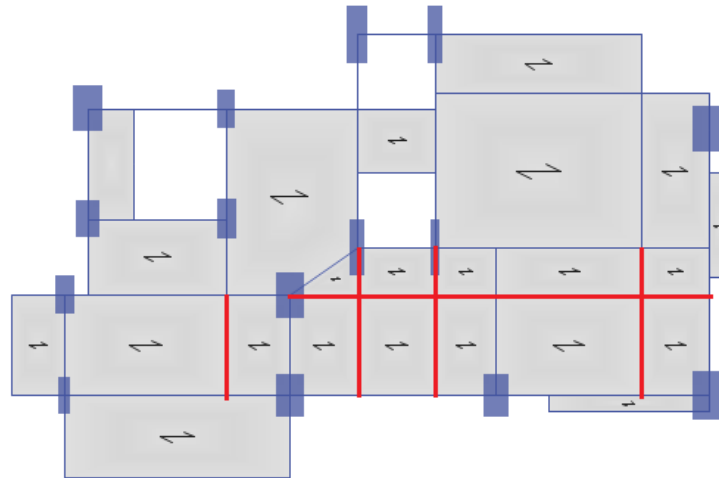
Columnas y vigas del piso “tipo” NTC-Modal.
